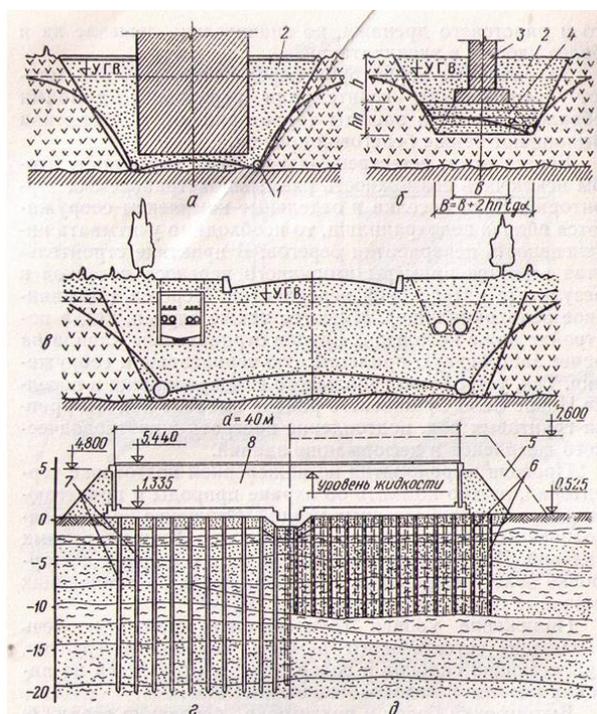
Схемы выторфовки и оснований сооружений: а – полная выторфовка; б – частичная выторфовка; в – полосовая выторфовка; г – свайные основания; д – основание из дрен с пригрузом; 1 – дренаж; 2 – засыпка песком; 3 – фундамент; 4 – песчаная подушка; 5 – грунтовый пригруз (временный); б – песчаные дрены; 7 – сваи; 8 – отстойник
